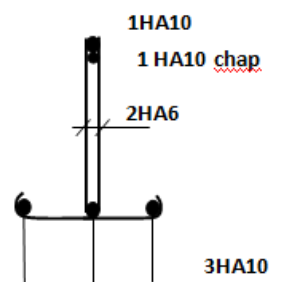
Plan de ferrailage de poutrelle en appui
